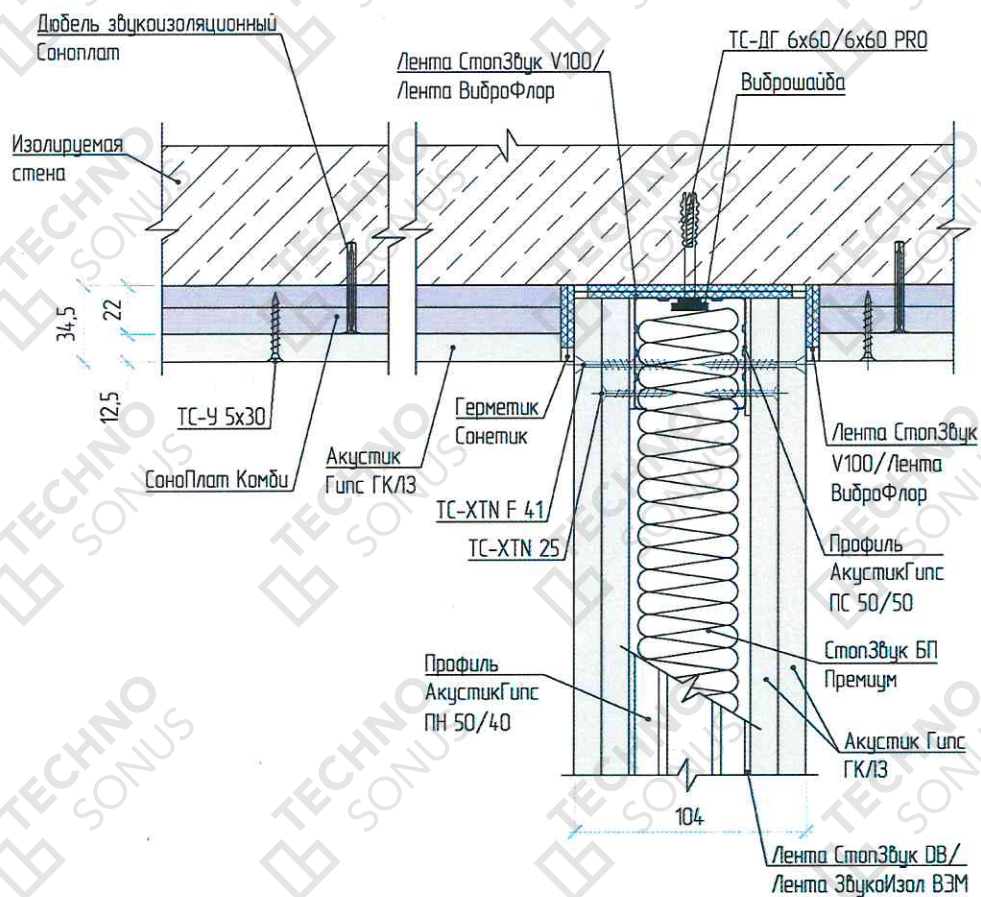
Примыкание облицовки стены «Слим П» к перегородке
